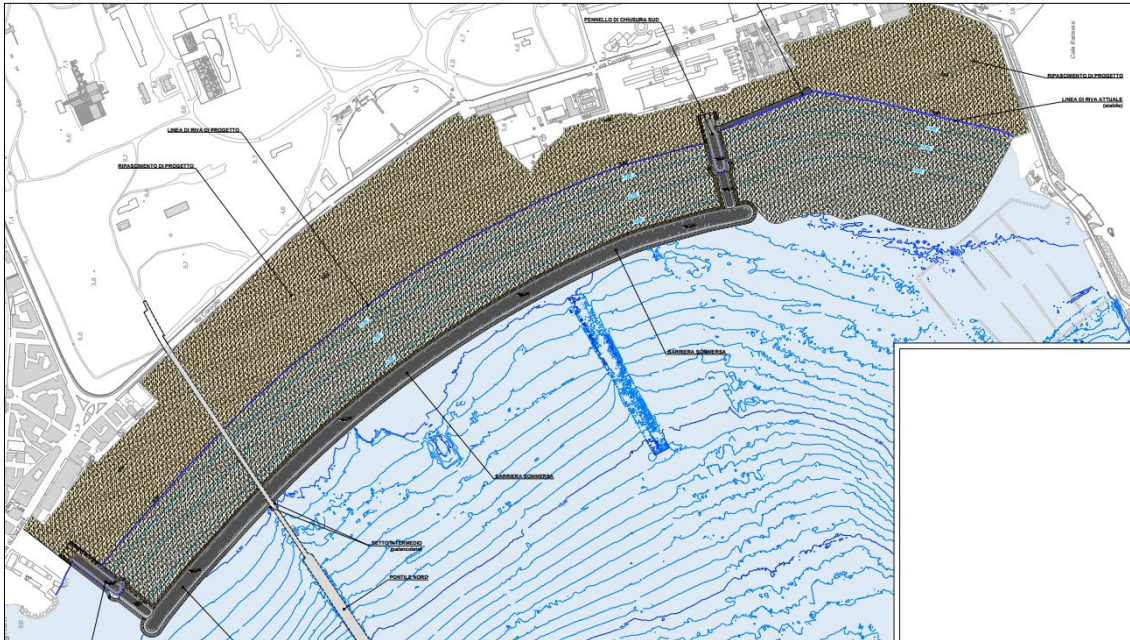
Planimetria di progetto con la nuova linea di costa da raggiungere al termine delle attività
